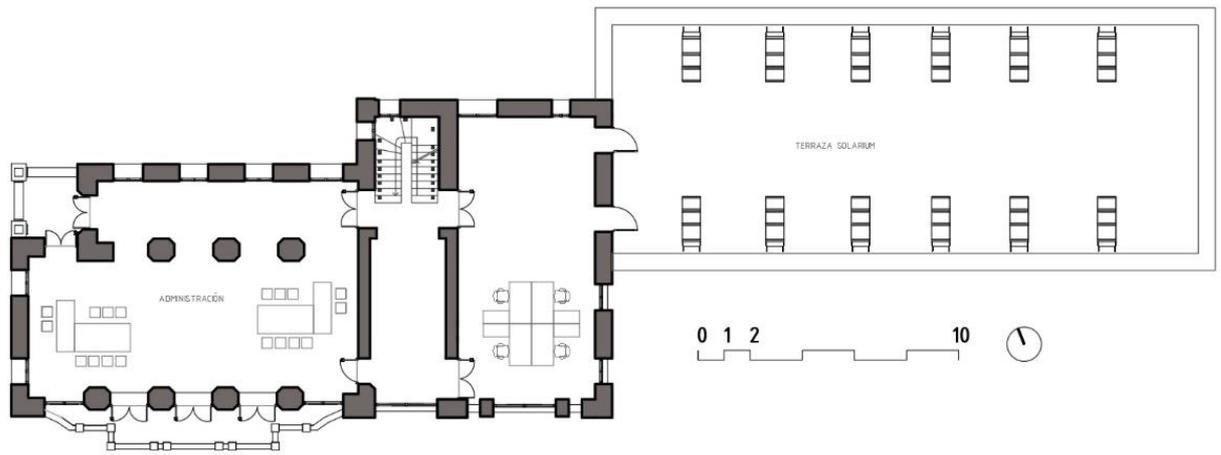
Hipótesis del Sanatorio de Cesuras, planta primera. Elaboración propia
